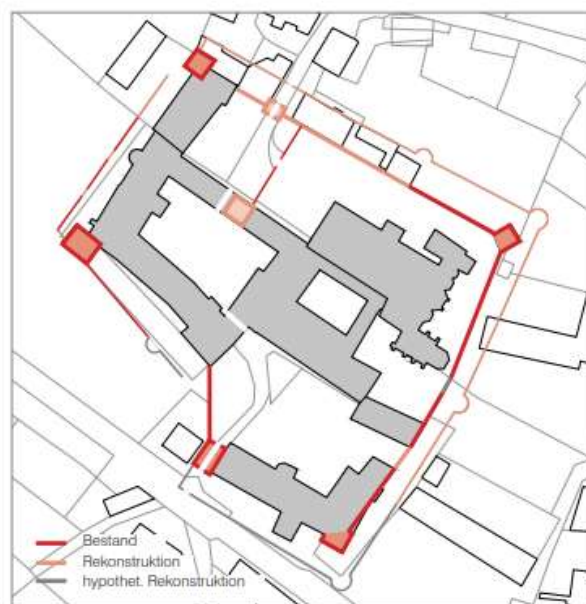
Schematischer Grundriss der Klosteranlage nach dem letzten Ausbau unter Hans Siebenhirter mit Kennzeichnung der Türme, der Ringmauerabschnitte und des Zwingers. (© Wolfgang, Plangrundlage © KAGIS)
